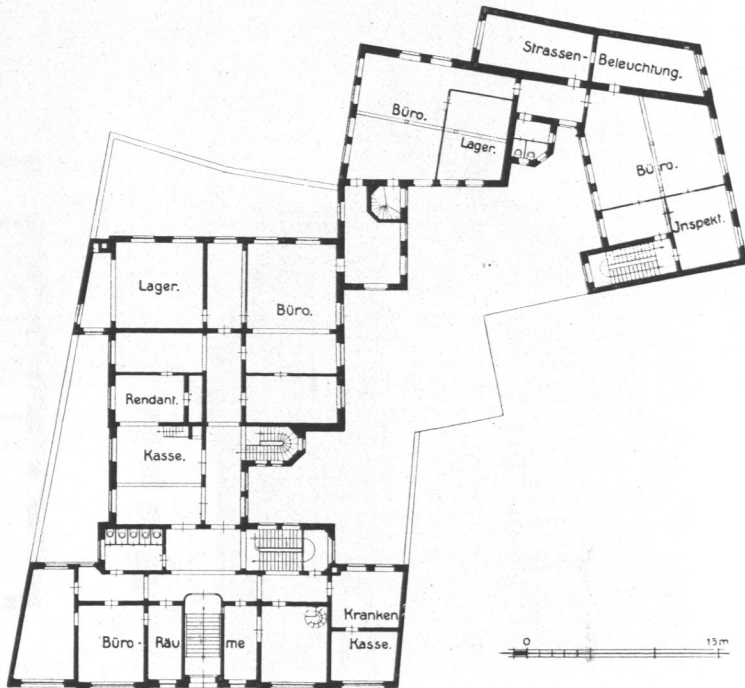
Dienstgebäude für das Beleuchtungswesen, Grundriß, Erdgeschoß.
